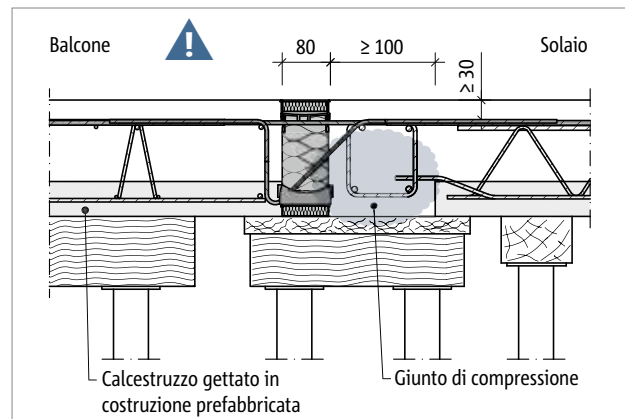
Schöck Isokorb® T tipo K/K-F: appoggio indiretto, montaggio con solette semiprefabbricate (qui:  $h \leq 170$  mm), giunto di compressione lato solaio
